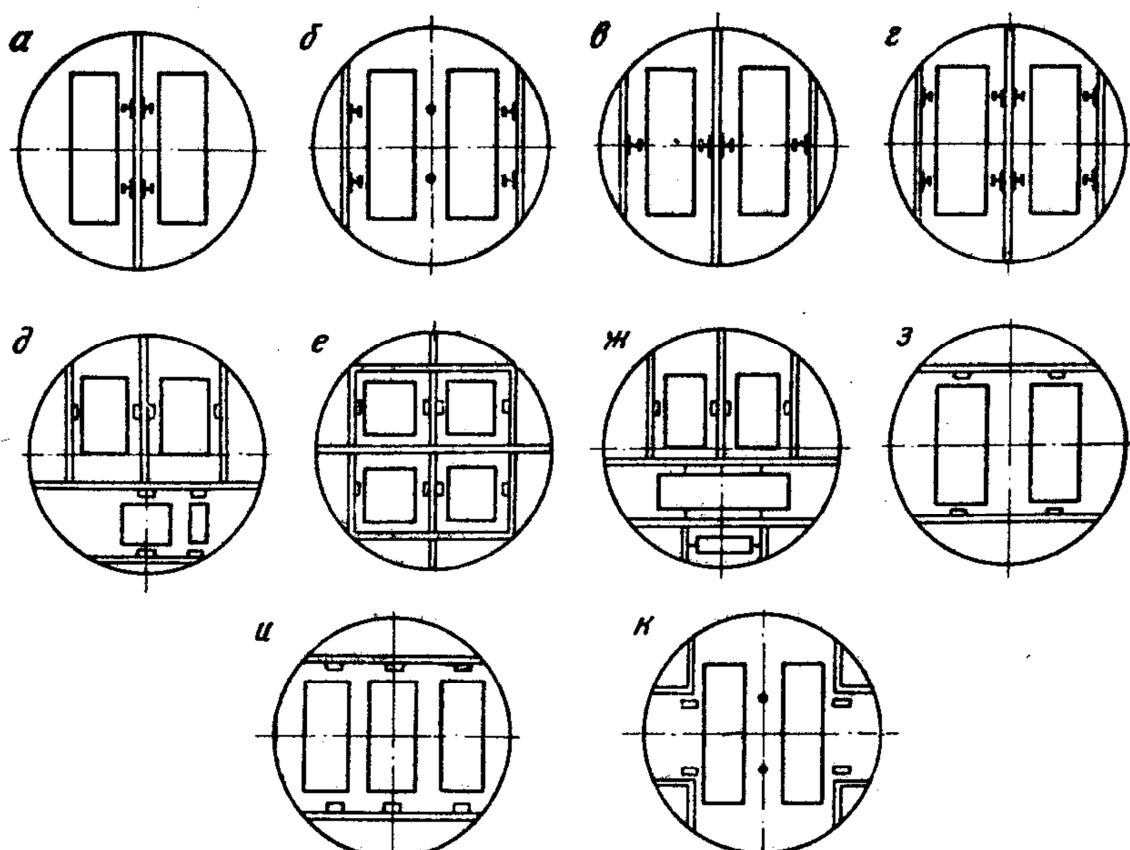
Характерные схемы сечений стволов с жесткими армировками
